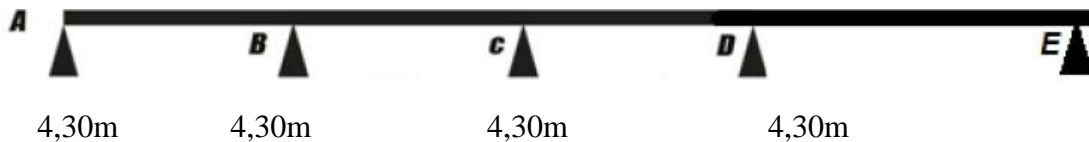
Schéma du 1^{eme} type de poutrelle.
